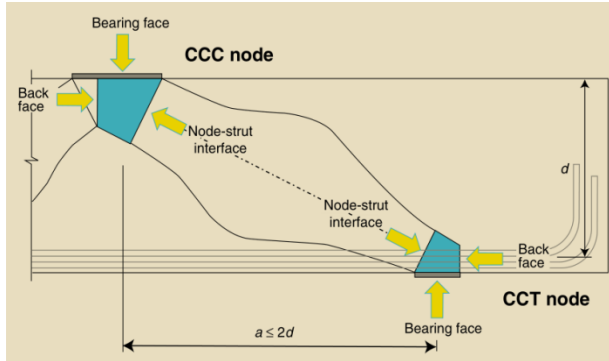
Связь между зонами сжатия в железобетонном элементе
